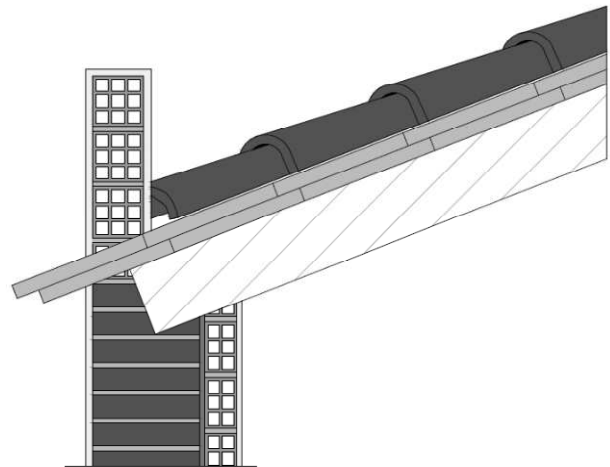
Fachada-Cubierta. Zona oeste. Estado original.
